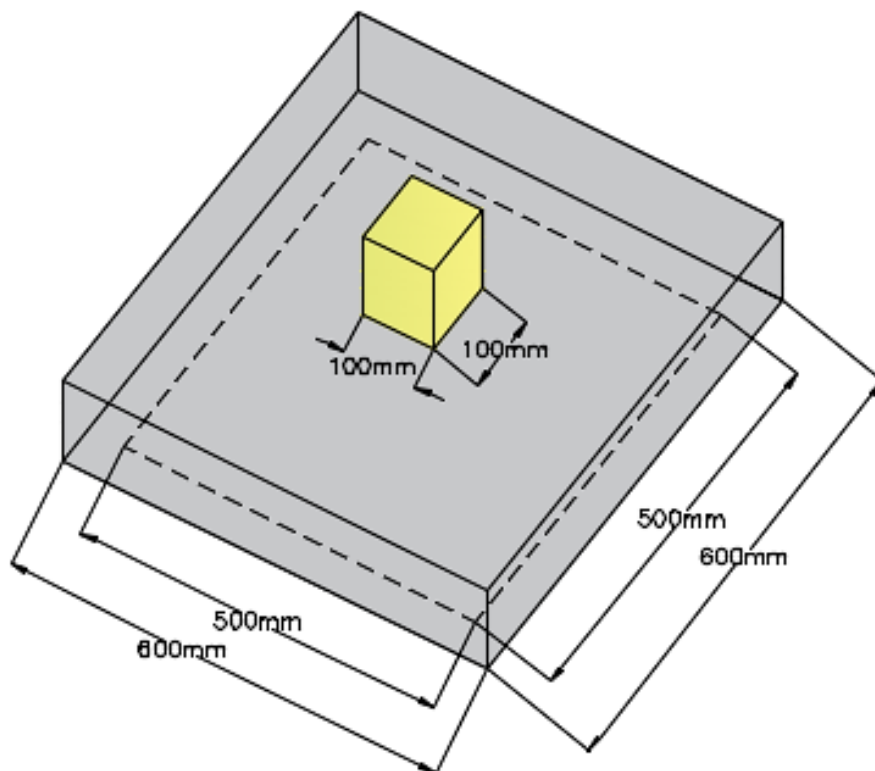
Detalle de la geometría de panel EFNARC. Fuente: Elaboración propia.
